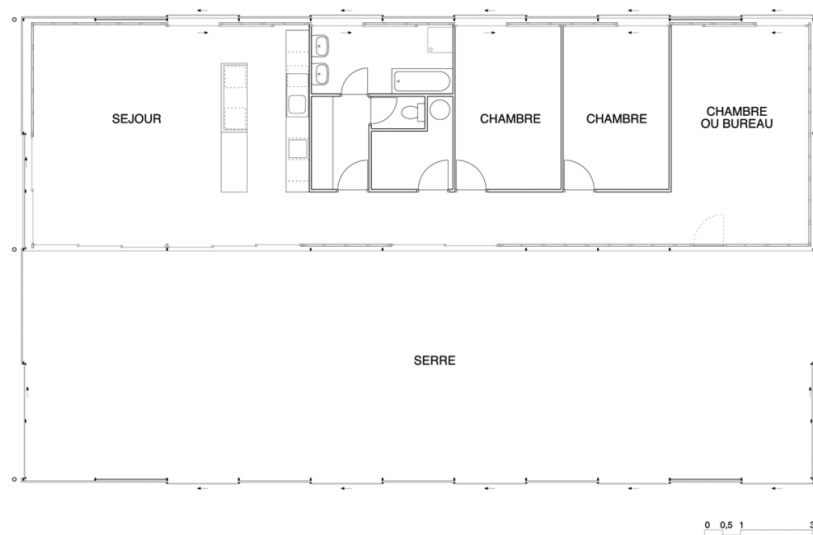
Casa em Coutras, Lacaton & Vassal - planta
